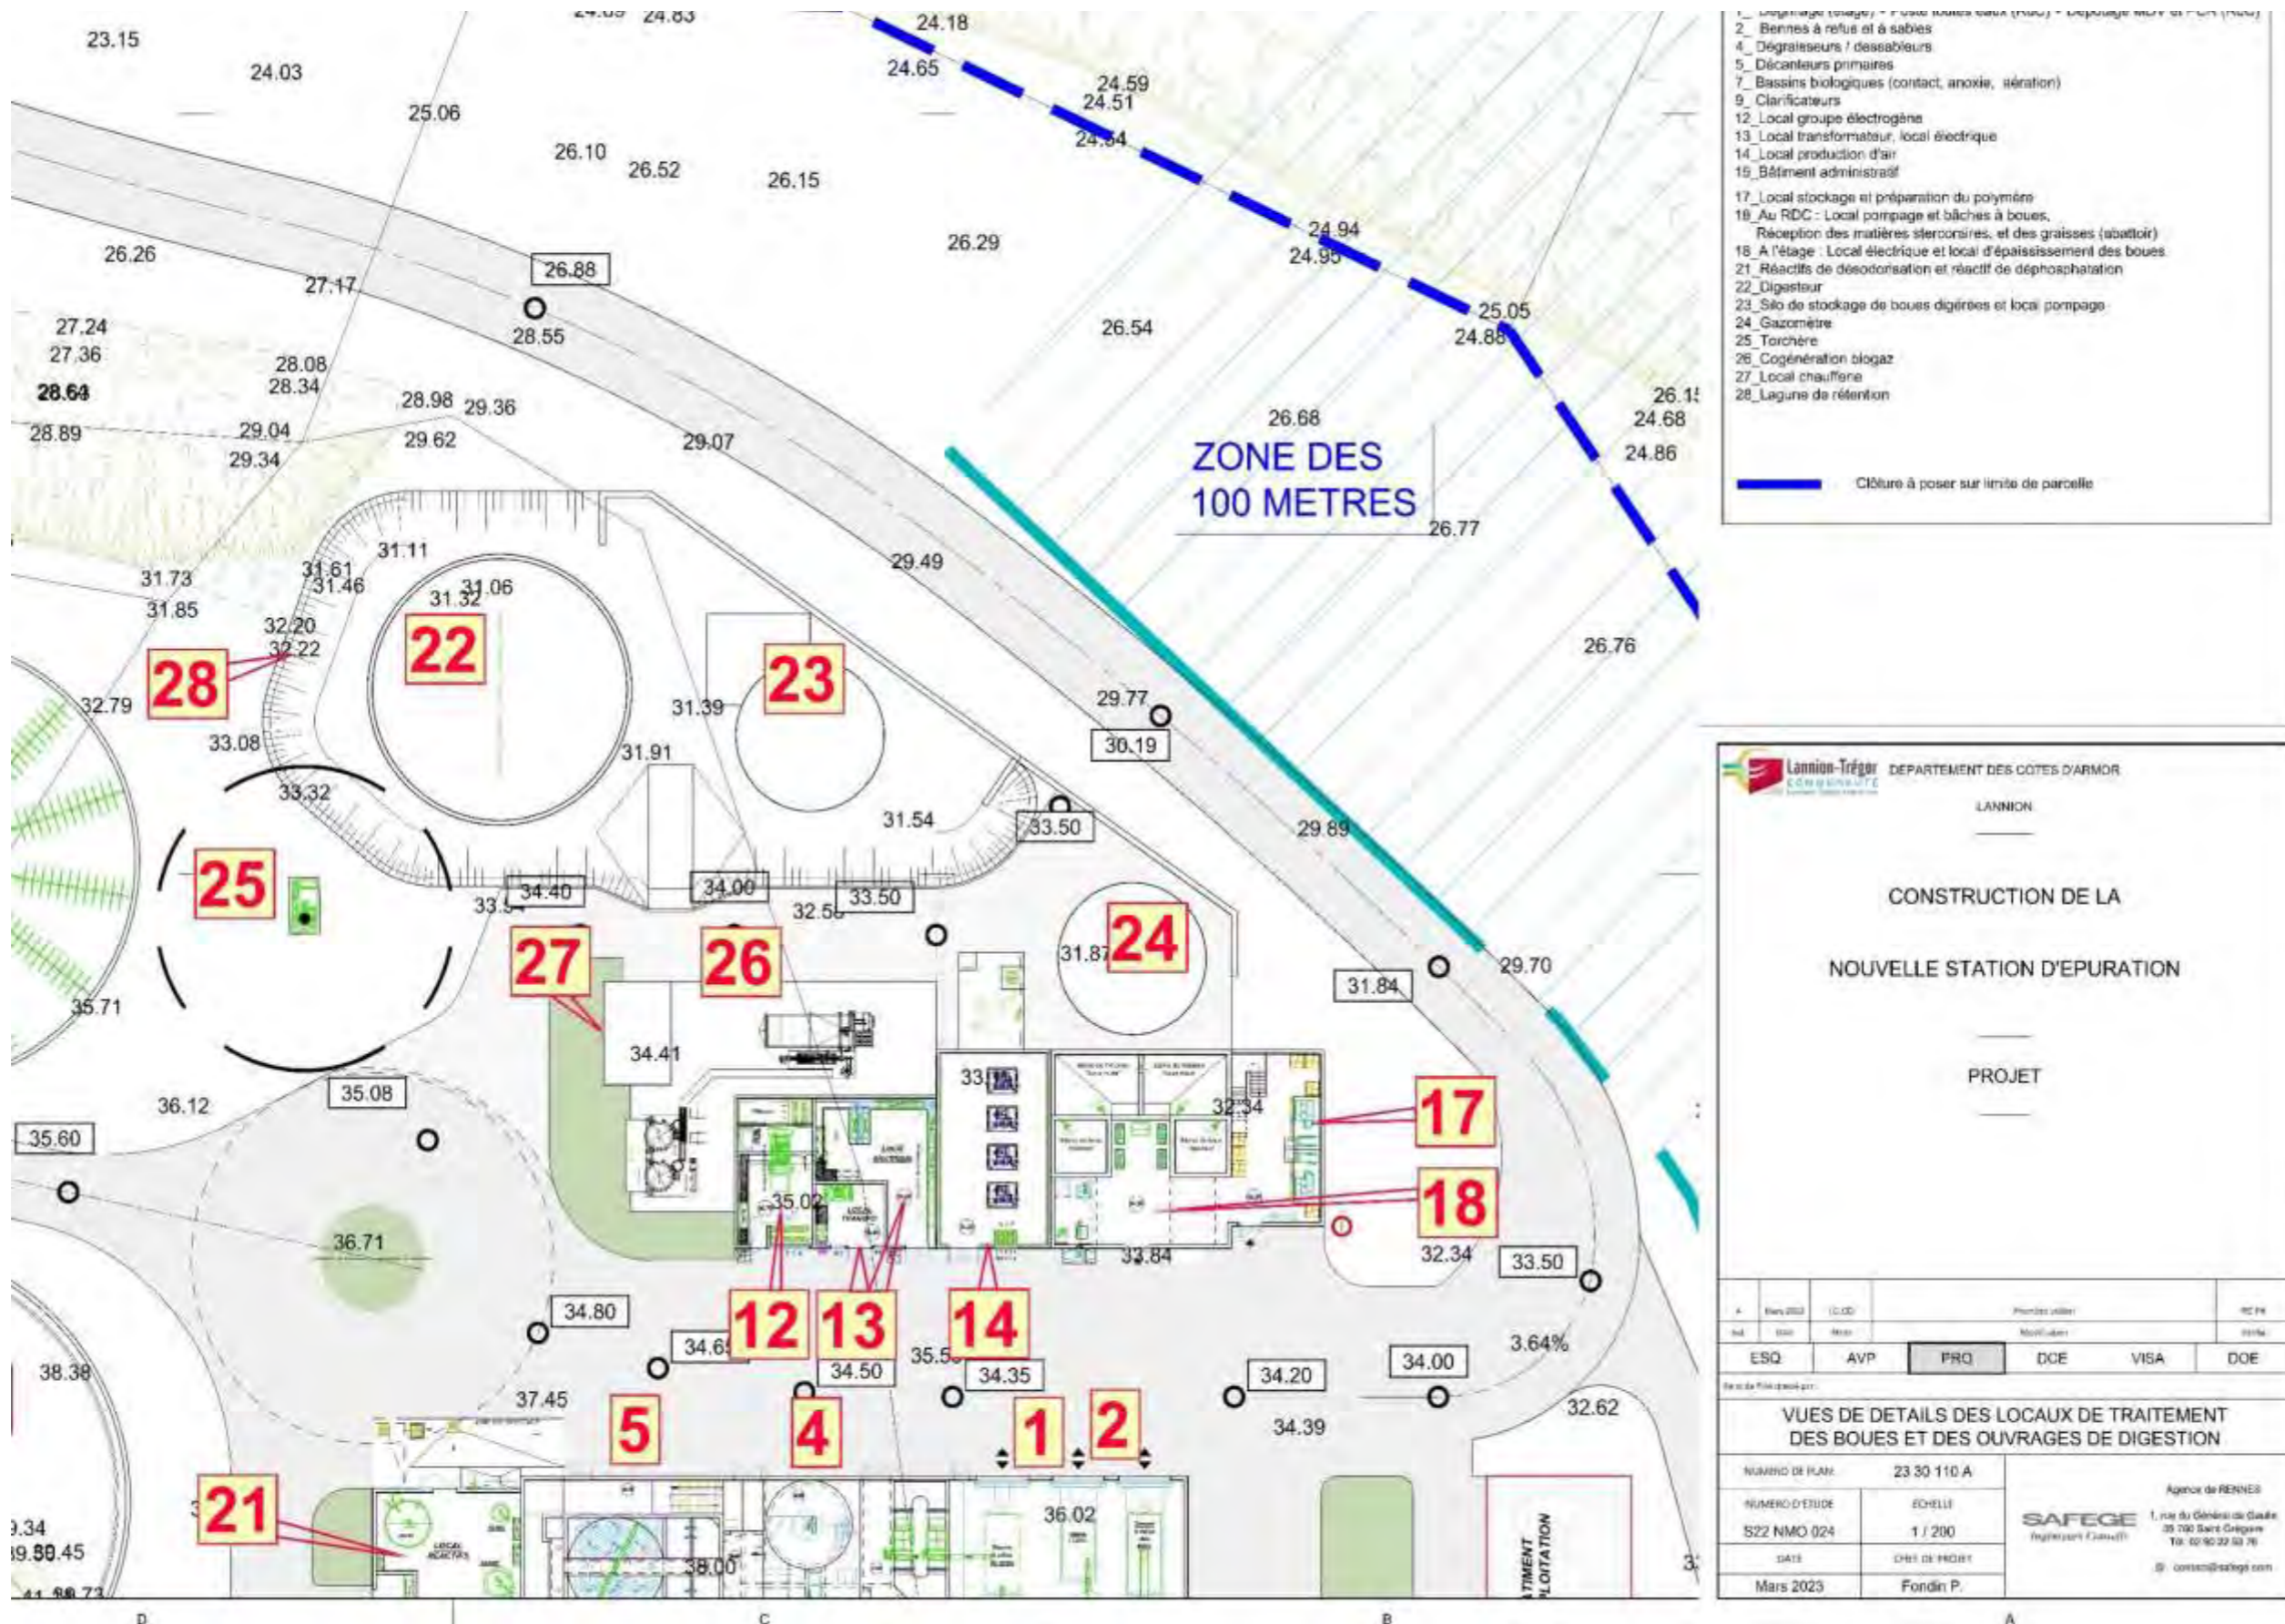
Plan des ouvrages de méthanisation avec cogénération
